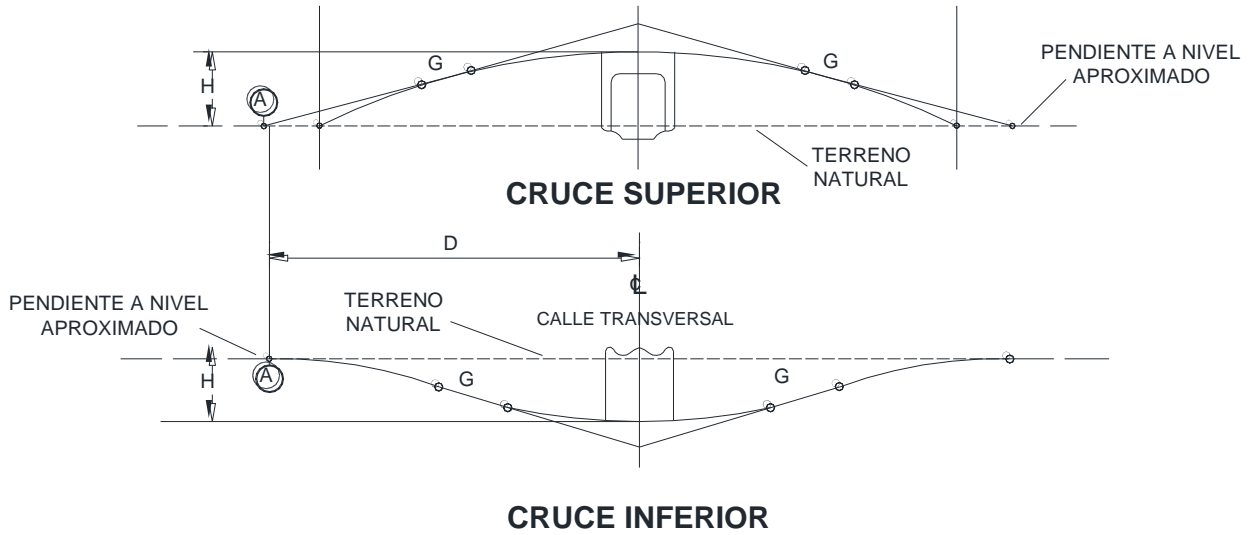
Terreno plano. distancia longitudinal necesaria para el diseño óptimo de una separación a desnivel
